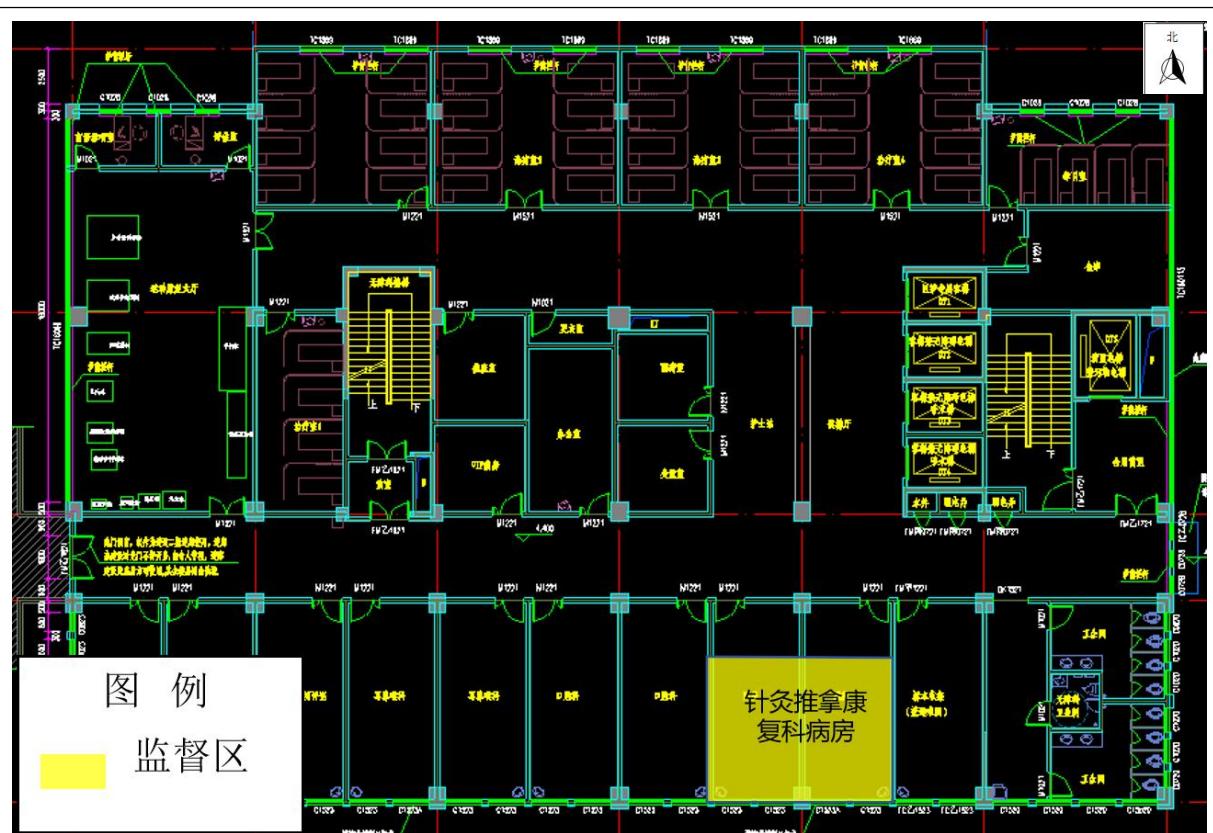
本项目辐射防护分区示意图（二楼平面图）
